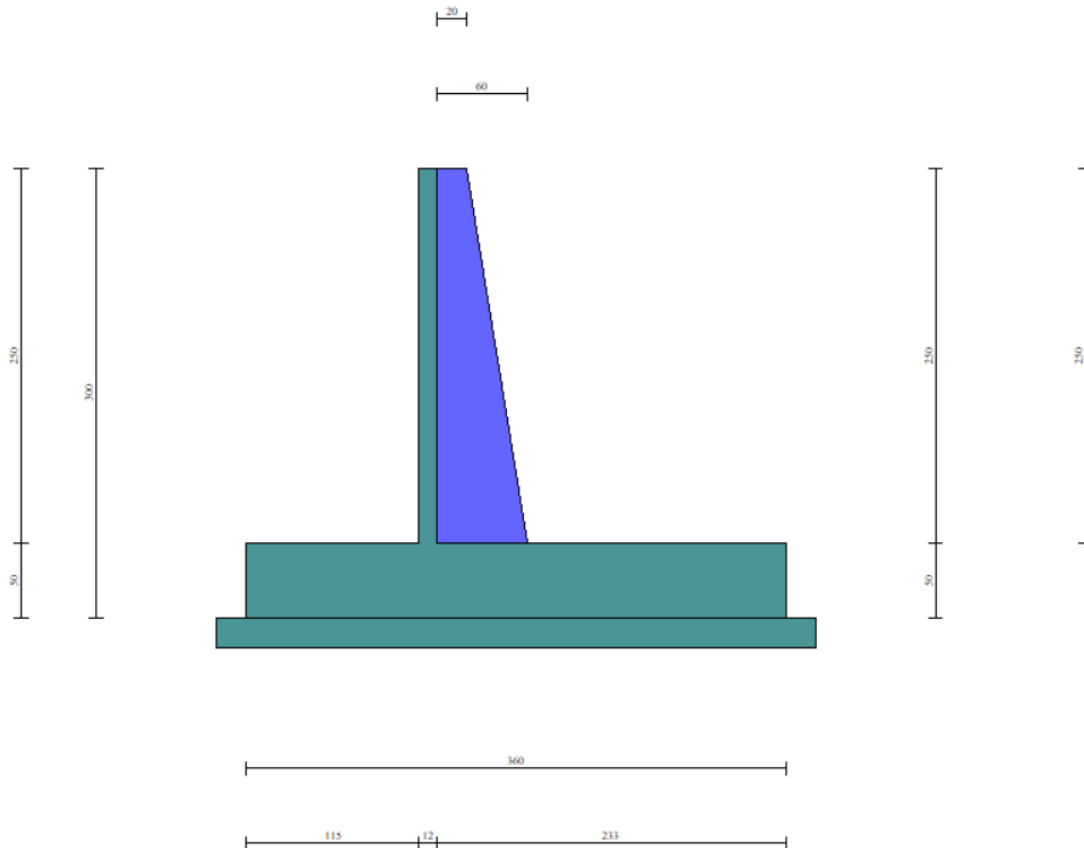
Geometria dei MURI DI SOTTOSCARPA - FONDAZIONE DIRETTA - TIPO 5
